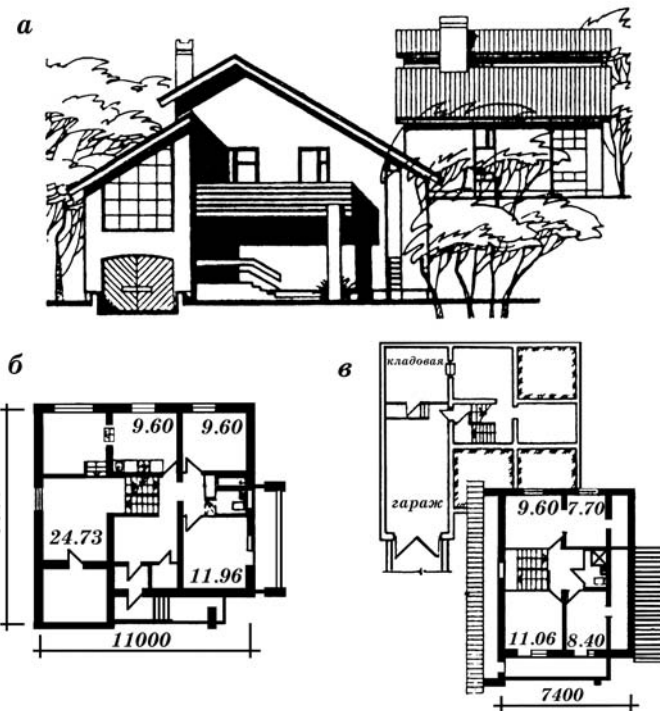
Усадебный жилой дом со стенами из мелкоформатных пустотелых бетонных камней: а – общий вид; б – план первого этажа; в – подвал с гаражом и мансардный этаж
